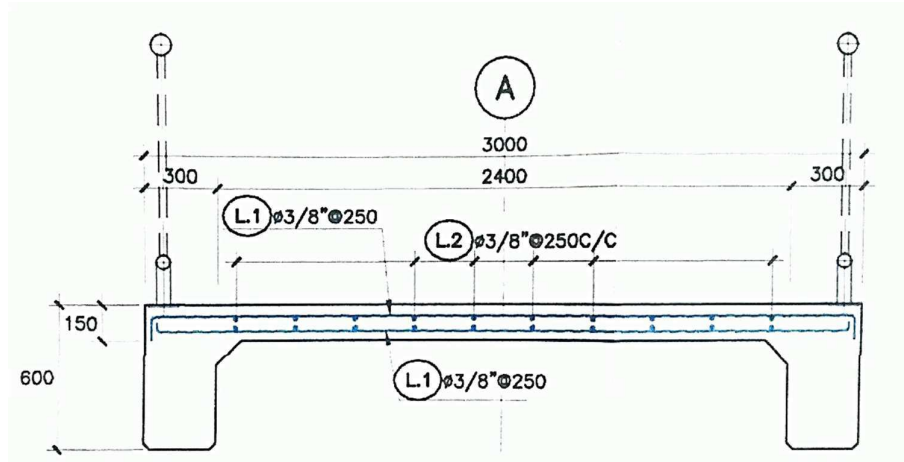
Sección transversal de la pasarela de acceso, losa de concreto armado.
